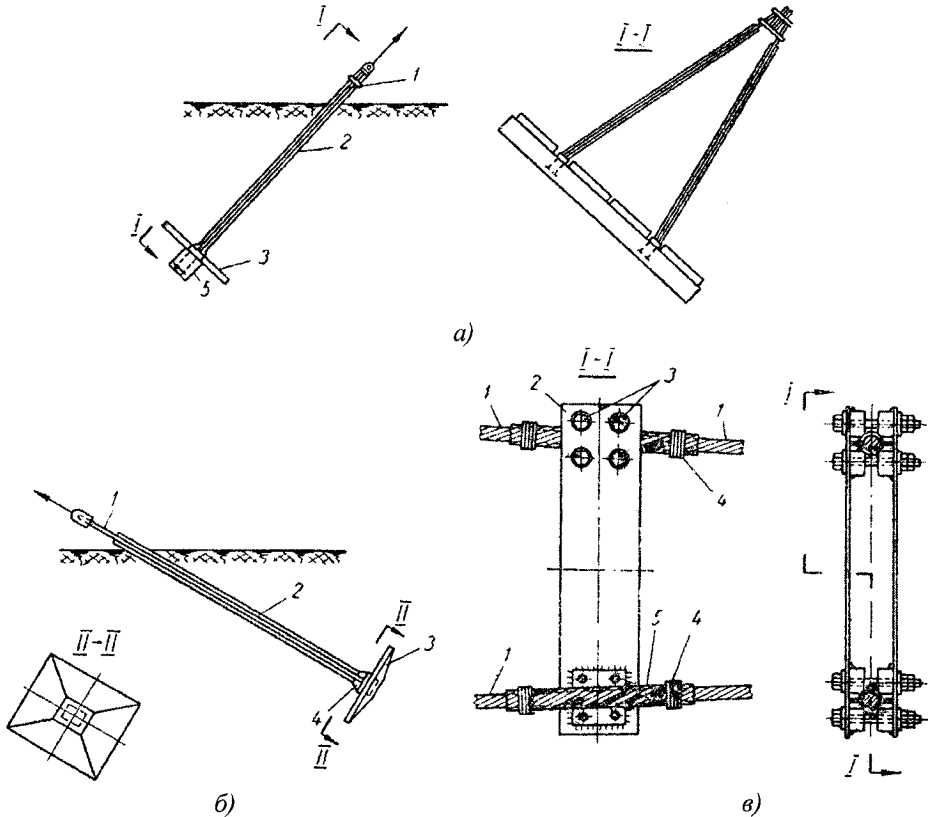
Закладні анкерні опори: а – з кількома щитами; б – з одним щитом: 1 – тяга від анкерного щита до канатів, 2 – ізоляція тяги, 3 – анкерний щит, 4 – закладна частина щита для закріплення тяги, 5 – залізобетонна балка; в – траверса для розведення канатів поблизу анкерних опор: 1 – канат, 2 – траверса із сталевих листів, 3 – болтові обтискачі, 4 – скрутка з алюмінієвого дроту, 5 – обгортка алюмінієвими листами
